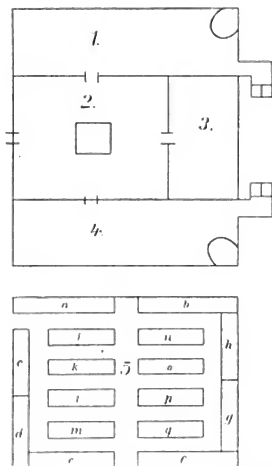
Arznei-Garten in Verbindung mit Krankenhaus und Arztwohnung auf dem Grundrisse des Klosters St. Gallen.
